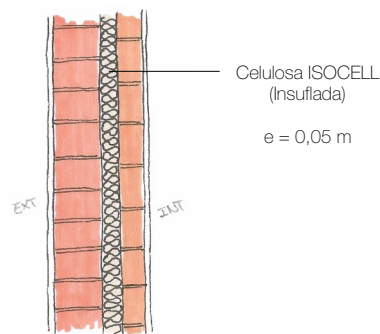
Sección de pared de balcón, terraza y patios interiores con aislamiento de inyección en cámara (autoría propia).
